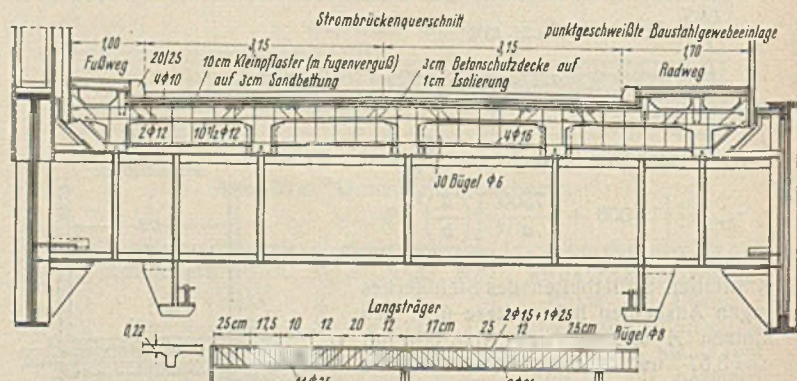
Eisenbeton-Brückentafel der Strombrücke.
